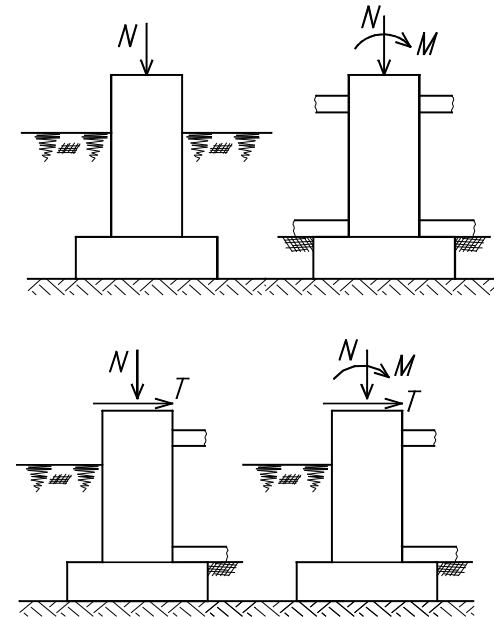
Расчетные схемы действия нагрузок на фундамент.
